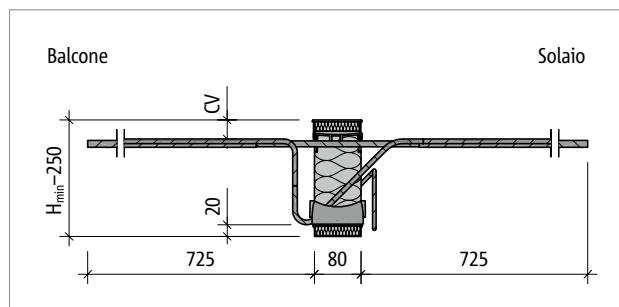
Schöck Isokorb® T tipo K-M7 – M11: sezione del prodotto
